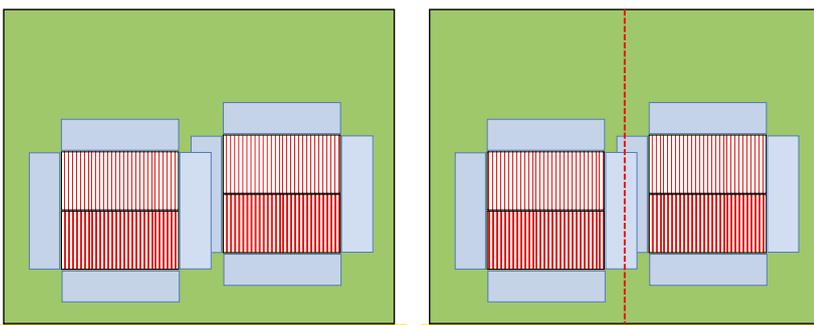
Teilung eines Grundstücks mit versetzten Gebäuden und sich überdeckenden Abstandsflächen; Teilung mittig
